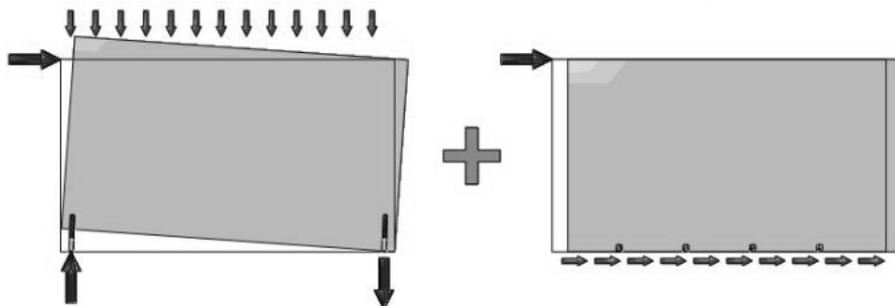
Azioni di sollevamento e scorcimento indotte dall'azione sismica agente nel piano della parete.
